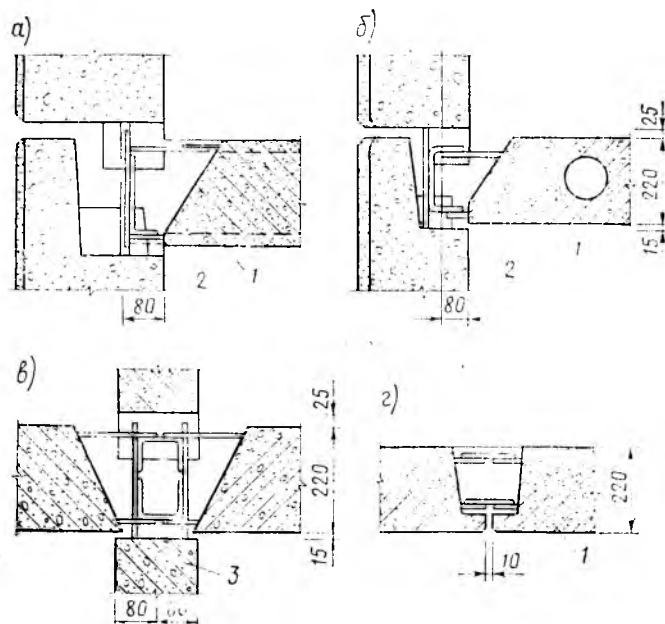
Узлы сопряжения несущих конструкций а — панели перекрытия (по поперечной грани) с наружной стеновой панелью; б — панели перекрытия (по продольной грани) с наружной стеновой панелью; в — панели перекрытия с внутренней стеновой панелью; г — панели перекрытия; 2 и 3 — наружная и внутренняя стеновые панели
